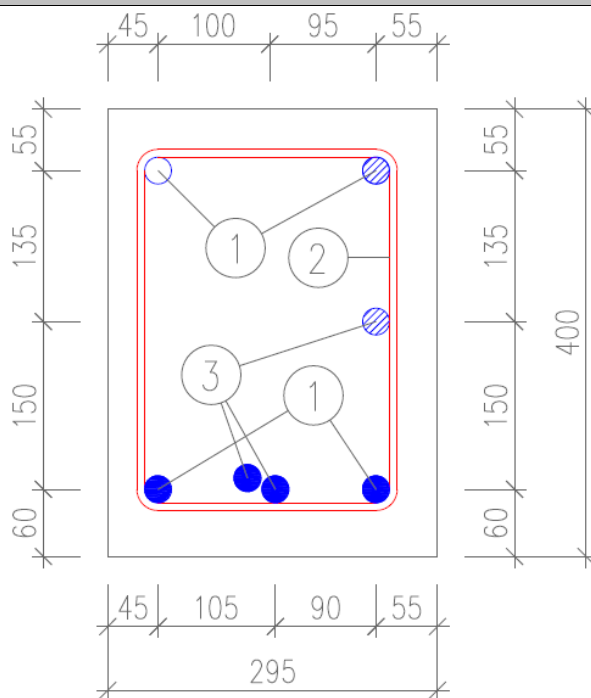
Měření krycích vrstev betonu konstrukční výztuže v rámci sondy D2.3 zábradelní železobetonové stěny
